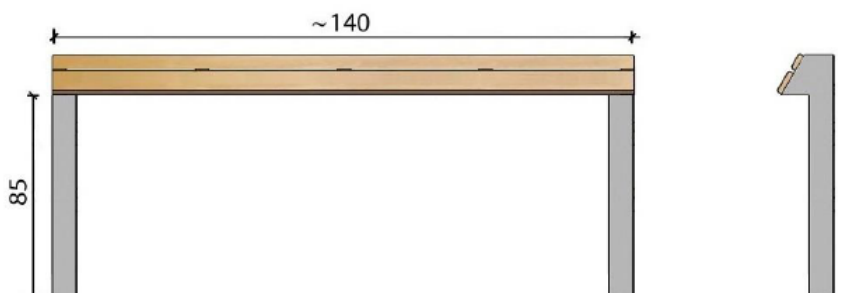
Przykładowa konstrukcja ławki – „lpi-1”.
